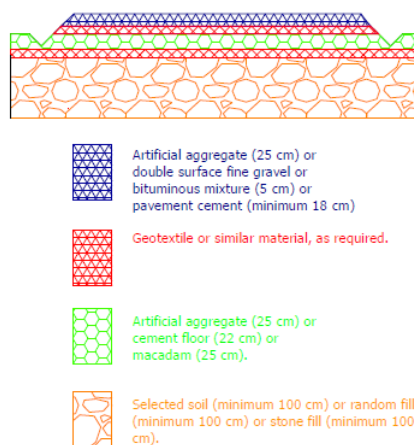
SEZIONE TIPO STRADALE N. 1
